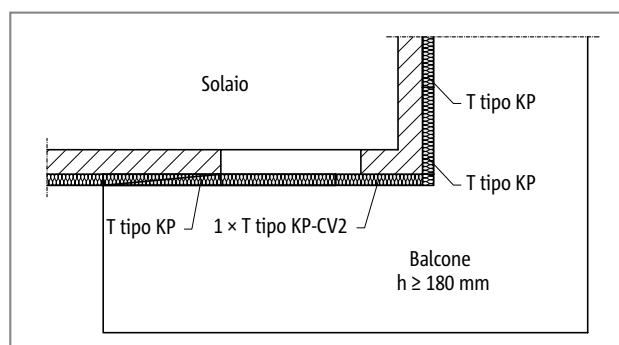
Schöck Isokorb® T tipo KP: balconi ad angolo esterno
